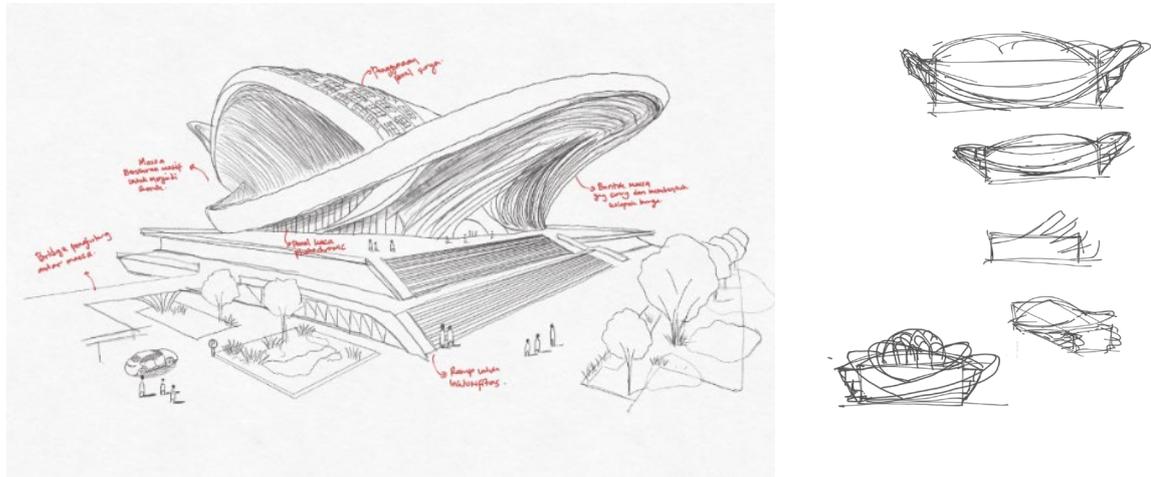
6 Hasil Eksplorasi Layout dari Blockplan
